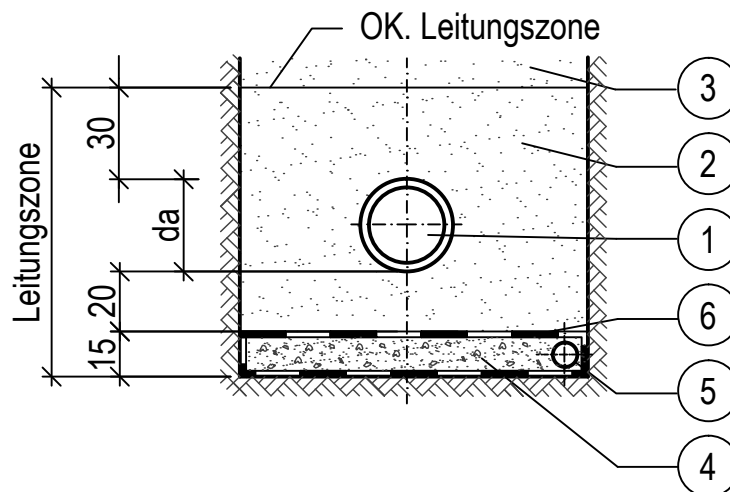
Einbau von biegesteifen Rohren DN ≥ 1200 bei Auflagerung auf Stahlbeton-/ Betonplatte
